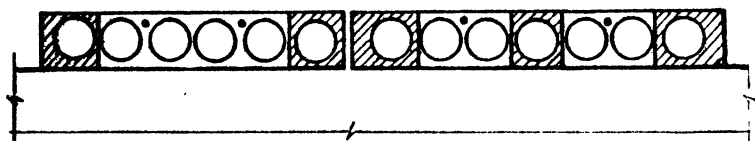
Узлы сопряжений монолитных стен со свободно опертыми плитами перекрытий:
